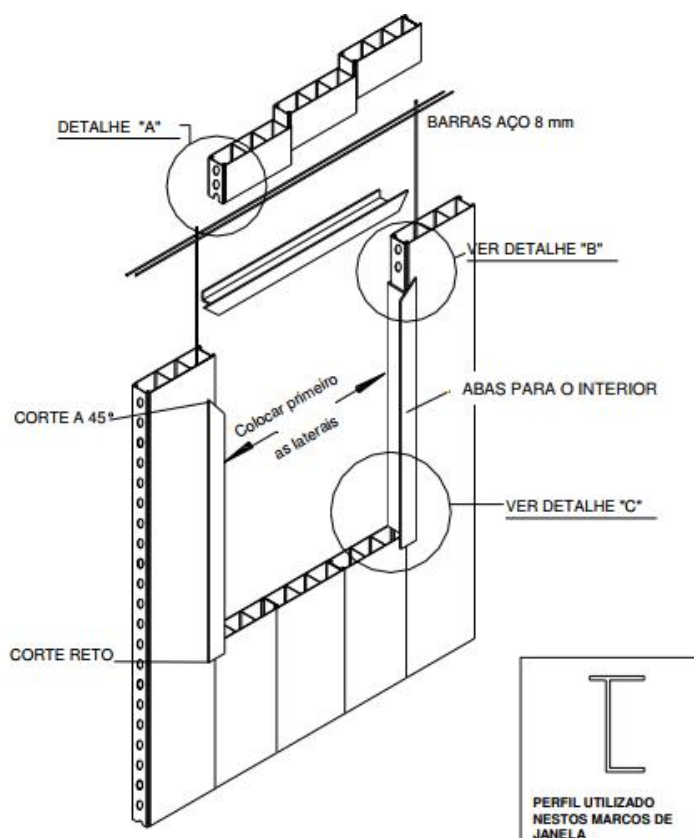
Montagem de parte da estrutura de concreto – PVC. No detalhe A podemos ver o corte do PVC para baixo onde passarão as barras. No detalhe B são mostrados o marco e as barras verticais de 8 mm. Já o detalhe C mostra o local que será fechado somente após a concretagem.
